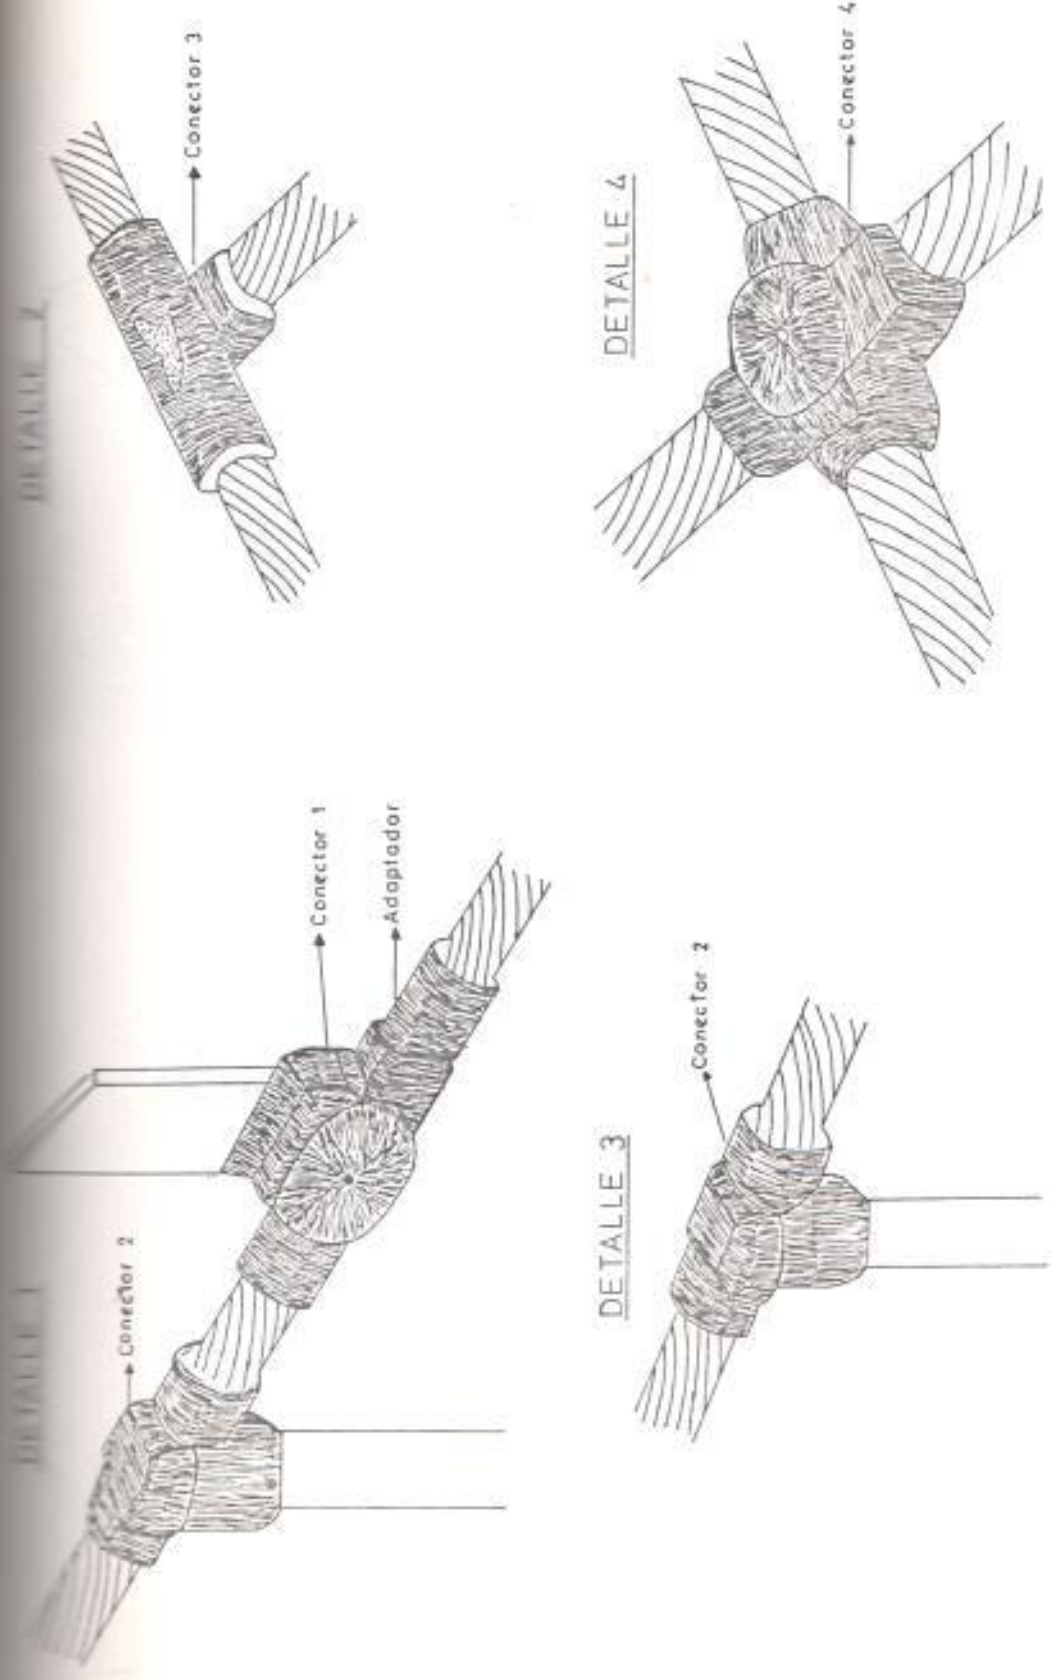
Detalles de conexión y tipos de conectores de puesta a tierra.
